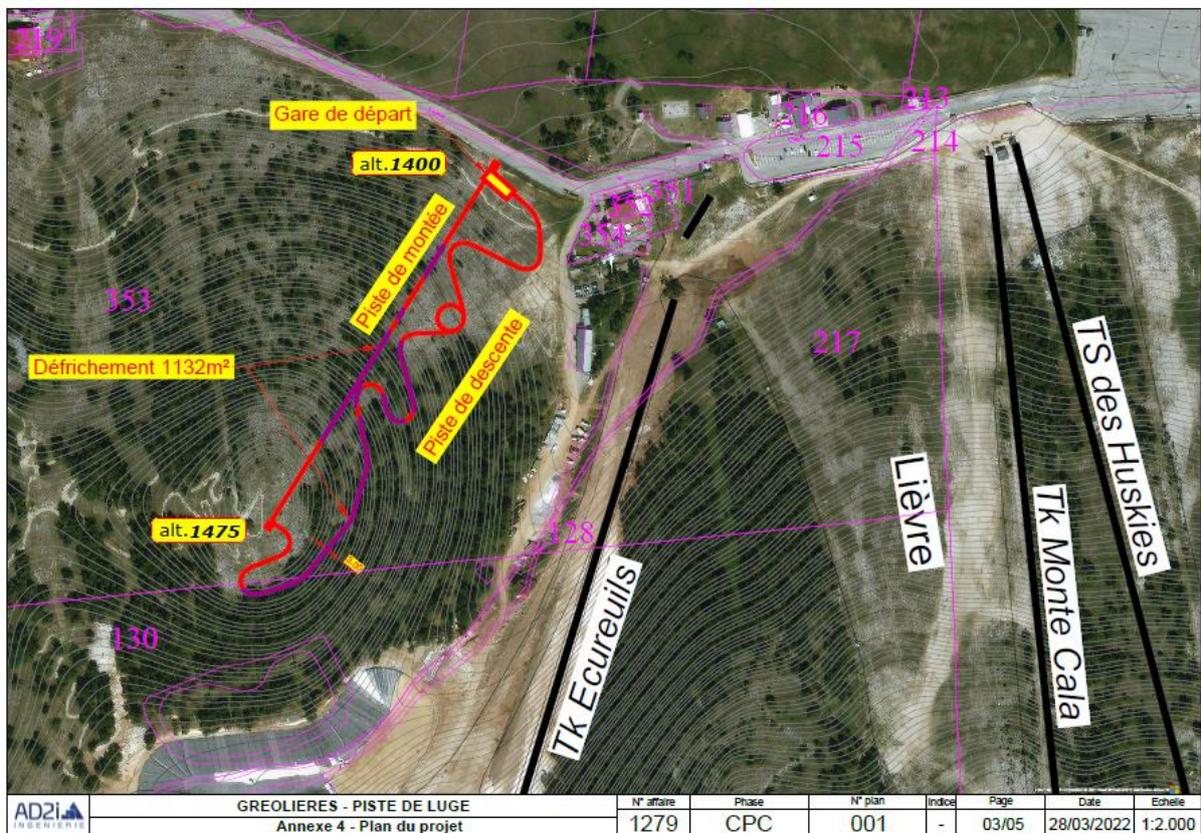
Vue en plan de l'installation projetée (source : AD2I)
